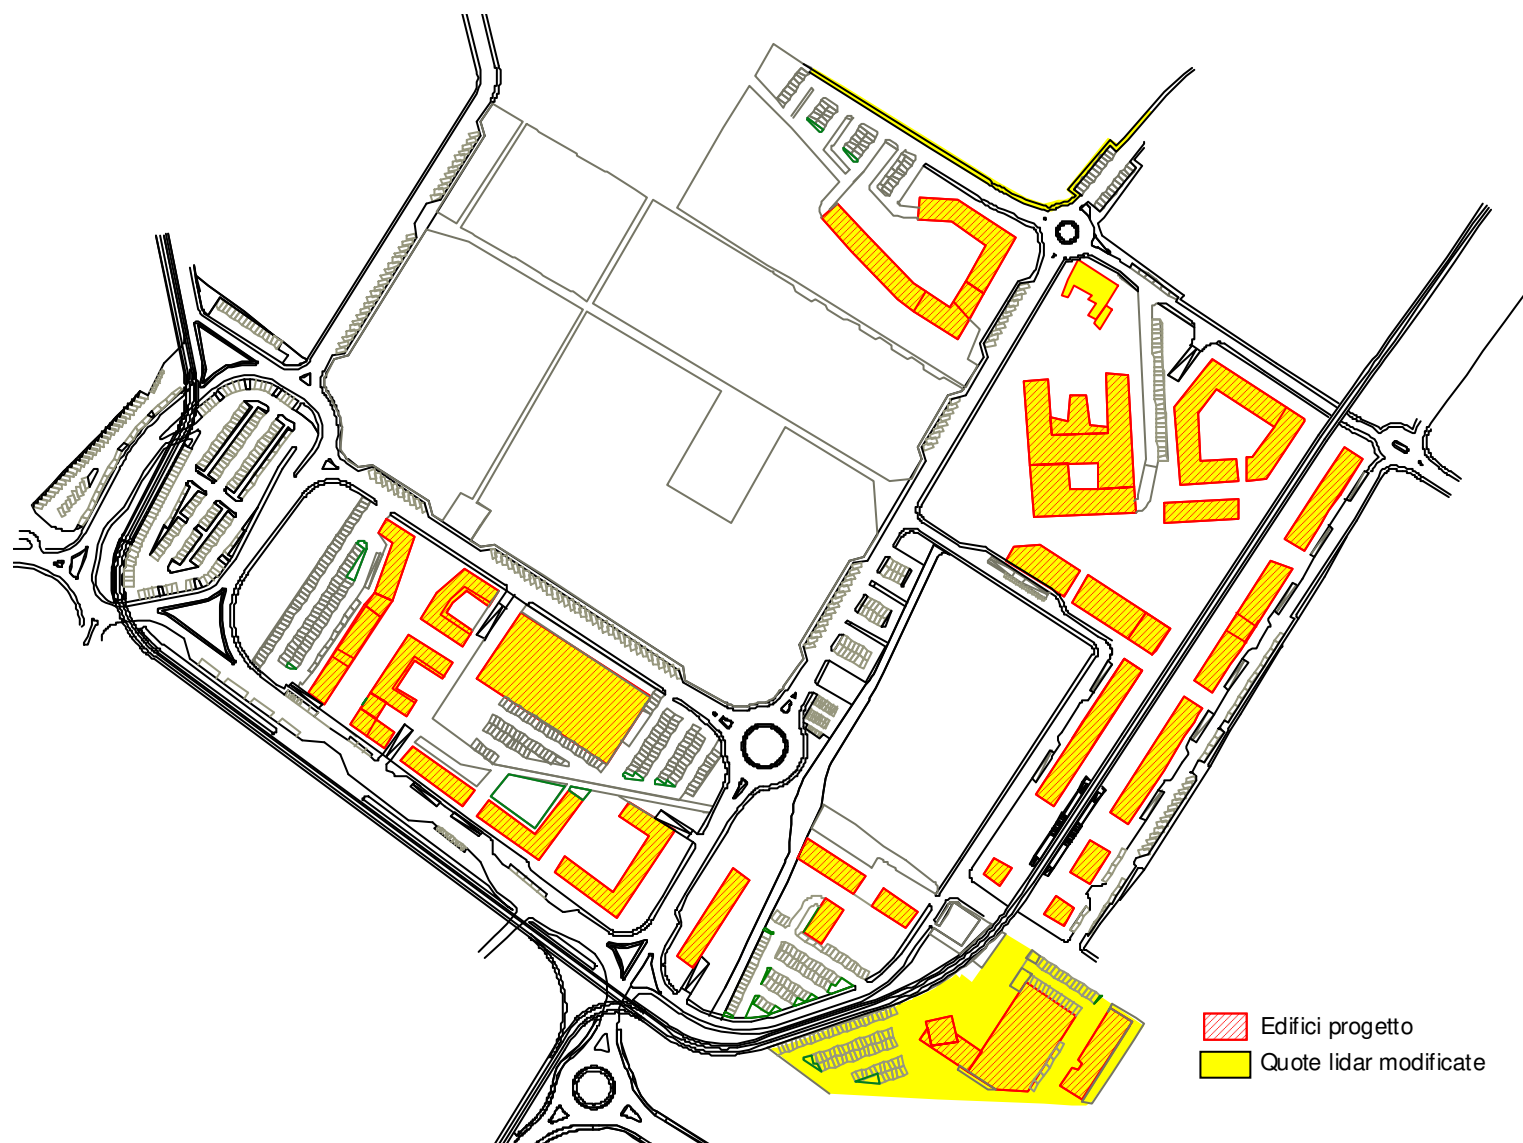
Planimetria della quote modificate per lo stato di progetto dell'Area di Trasformazione TR 04c.
